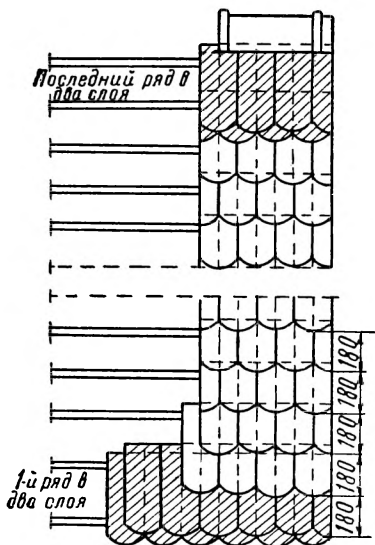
Двухслойное кровельное покрытие из плоской кровельной черепицы
